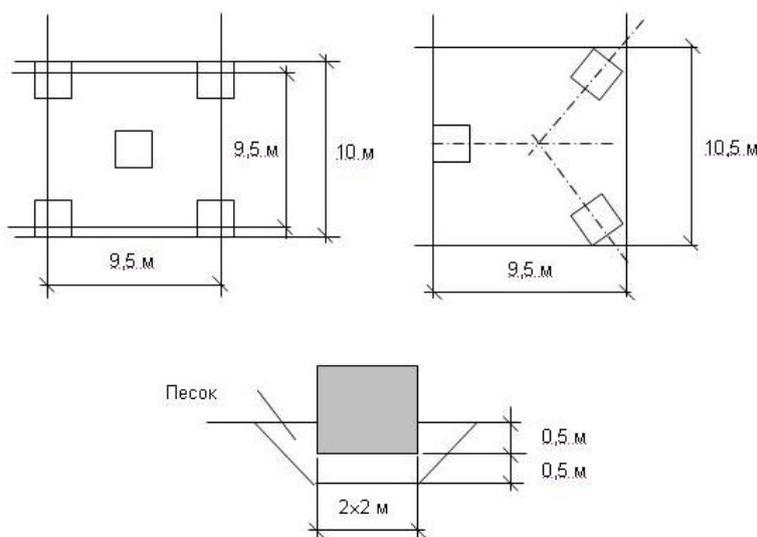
План и сечение пригруженных фундаментов мачт с оттяжками через  $90^\circ$  в плане и трёхгранных башен
